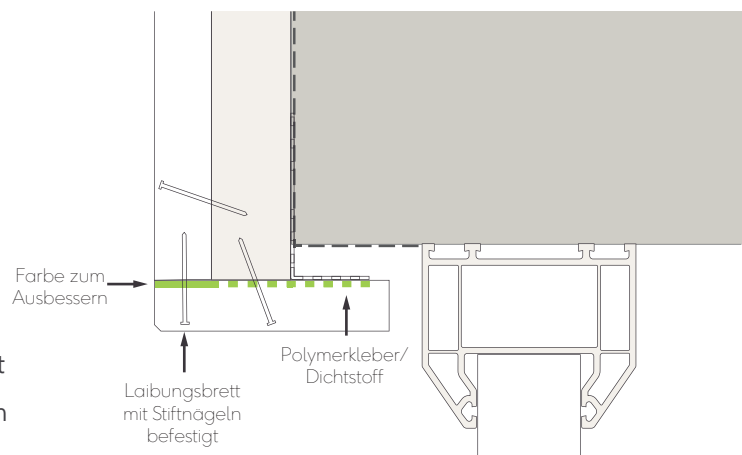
Fenster-/Türsturzverbindung mit bündigen Laibungsbrettern - Stoßverbindung und Stiftnägel
